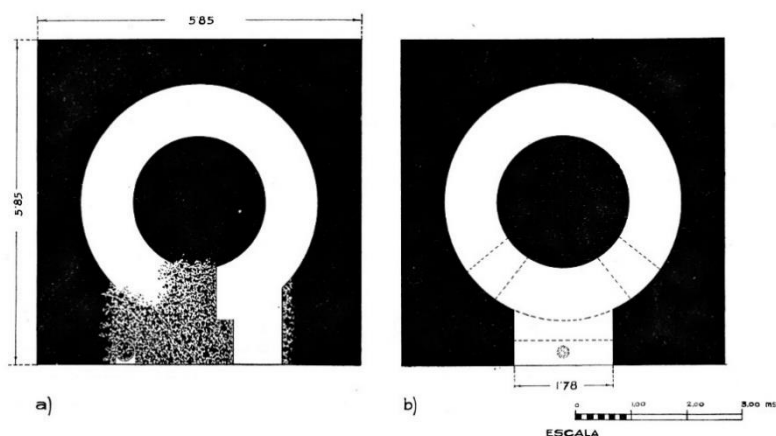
Planta baja y planta a nivel de ventana del alminar. (Hernández Giménez, 1975, Fig. 36)
